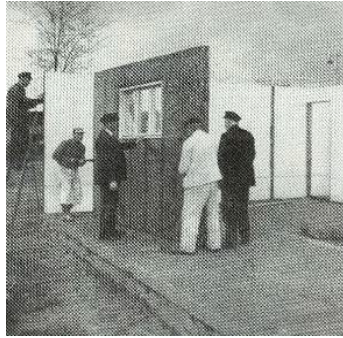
Crecimiento de una planta tipo del Packaged House System y ensamblaje de los componentes
